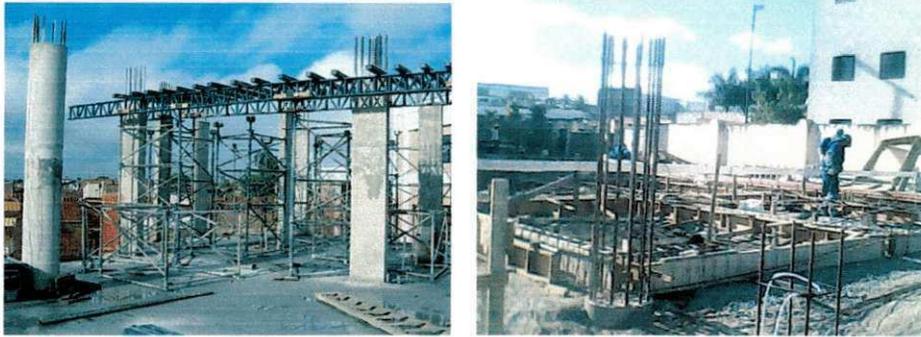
Fôrmas e escoramentos para lajes e vigas
